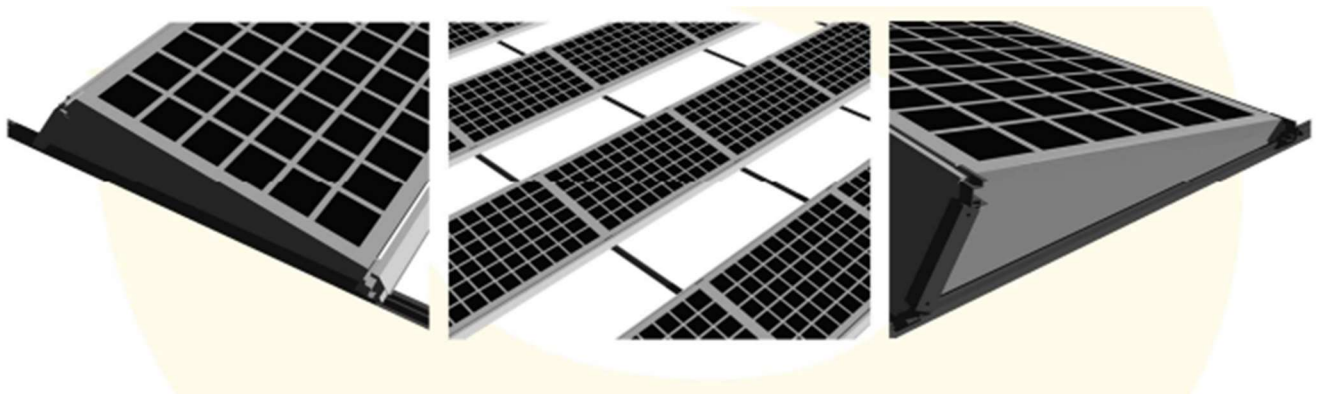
Estructura para instalación de módulos en la cubierta plana [2]
